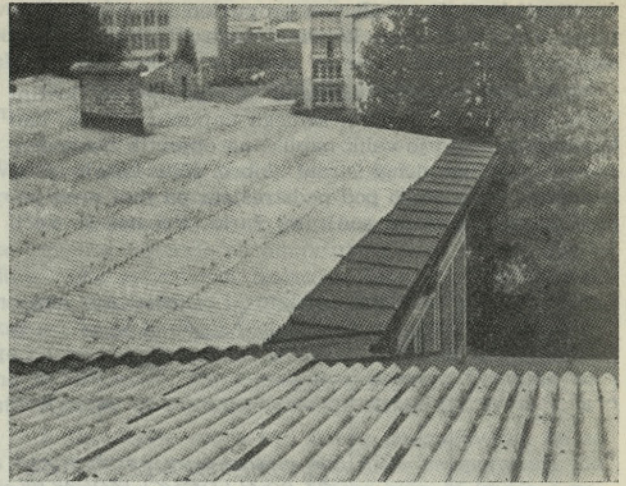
Primer zamakanja ob napušču zaradi slabega zračenja podstrešja in snegobrana
